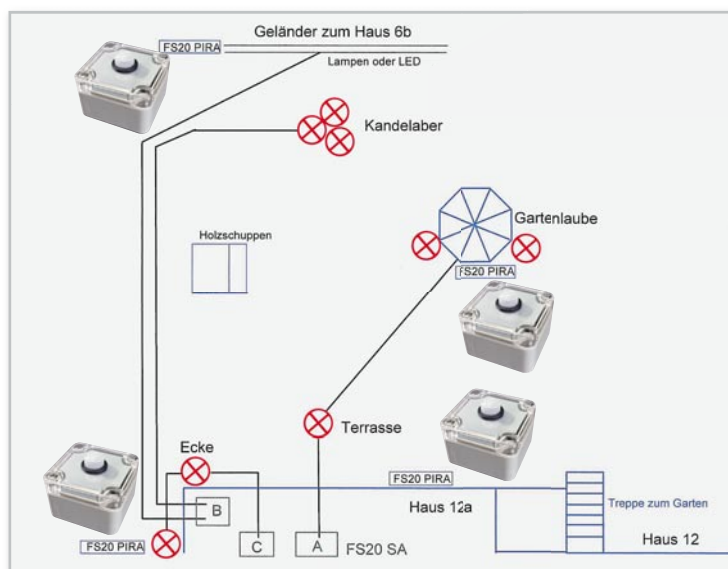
Der Lageplan für die zu platzierenden Beleuchtungs- und Steuerkomponenten
